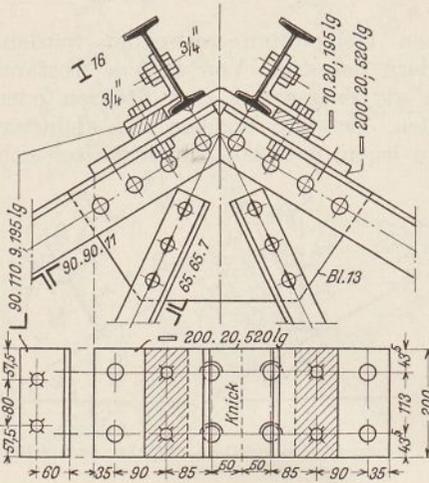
Firstknotenpunkt mit Doppelpfette.
